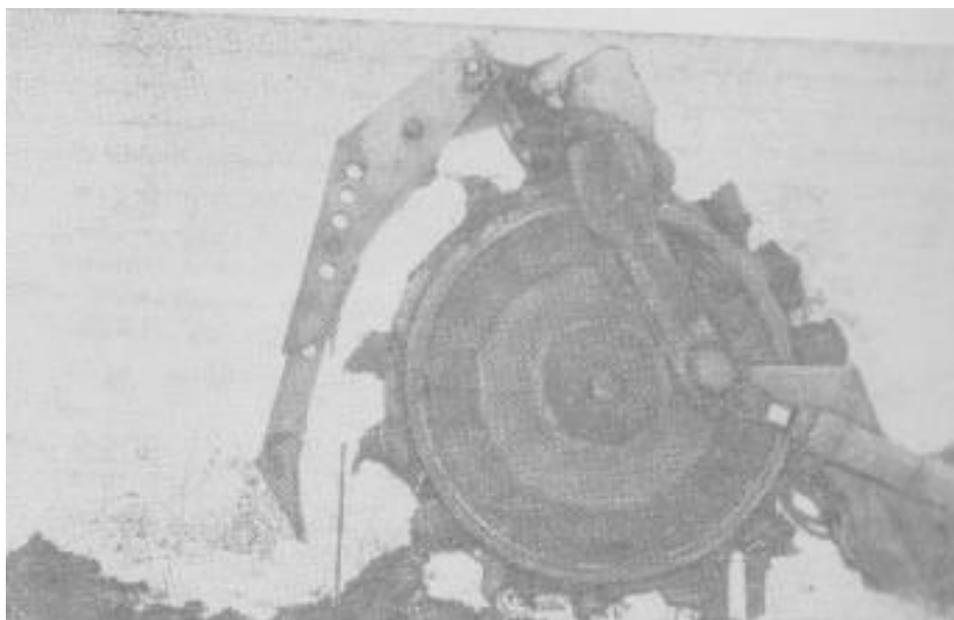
Дискофрезерный рабочий орган с выдвижным зачистным башмаком
